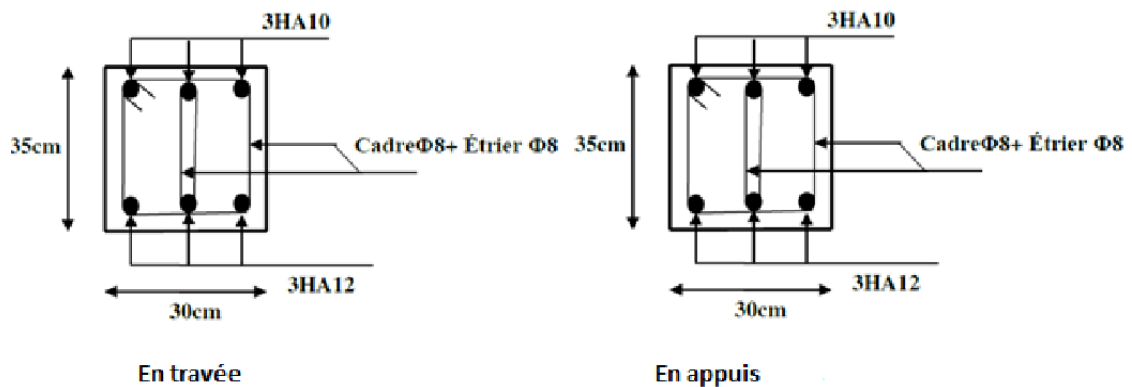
Schéma de ferrailage de la poutre de chaînage
